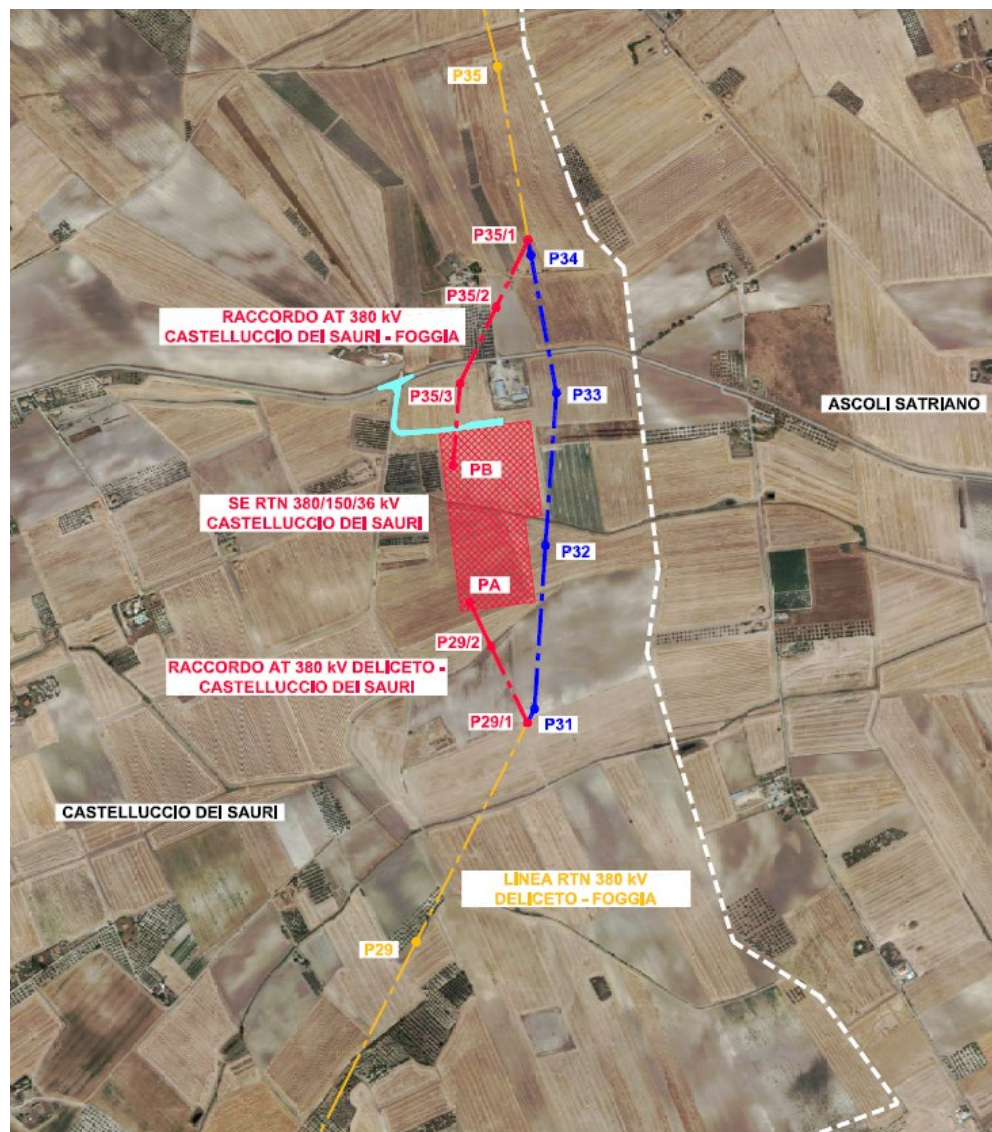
estratto dell’ortofoto con planimetria dei raccordi in progetto
